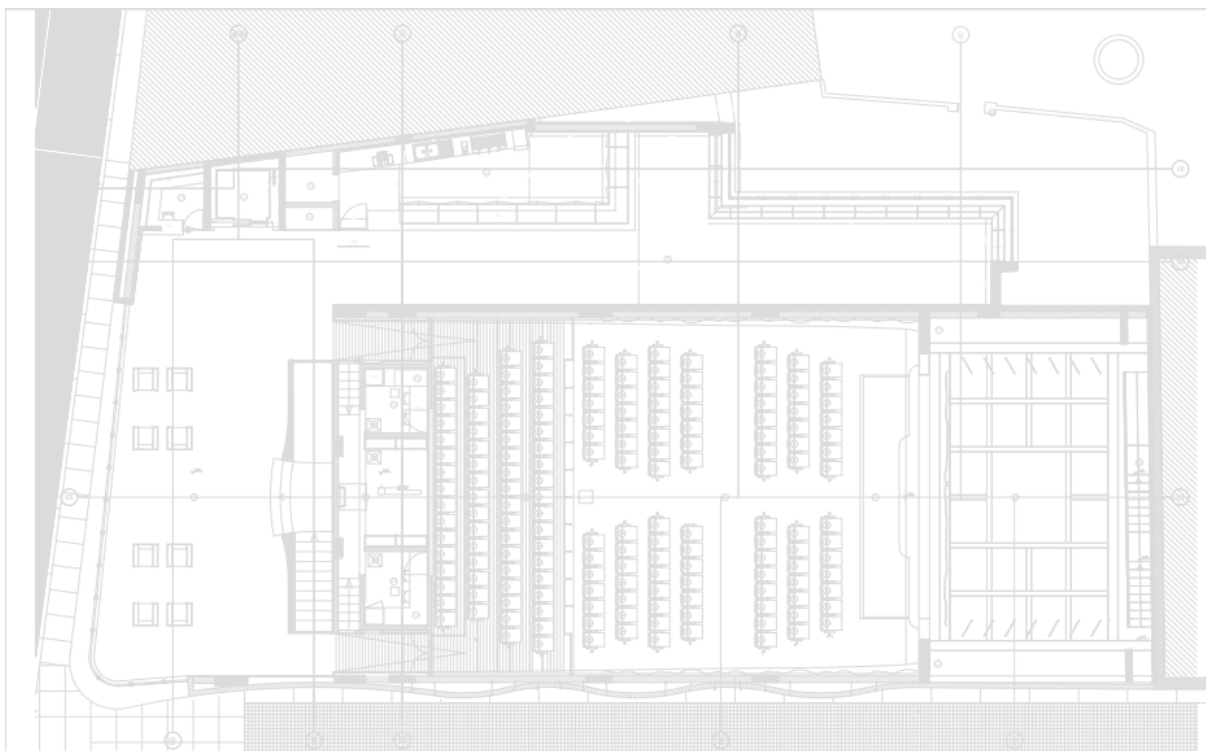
Planta do piso 1 do Cineteatro Eduardo Brazão [50]
